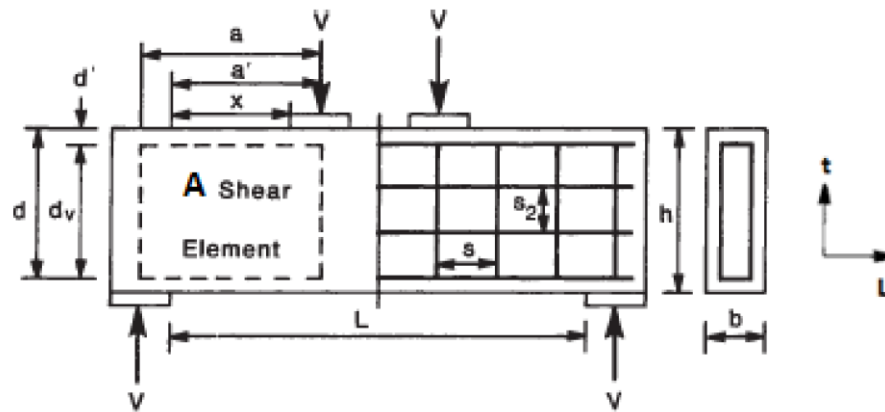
Geometría típica de ensayo de viga corta [20]
